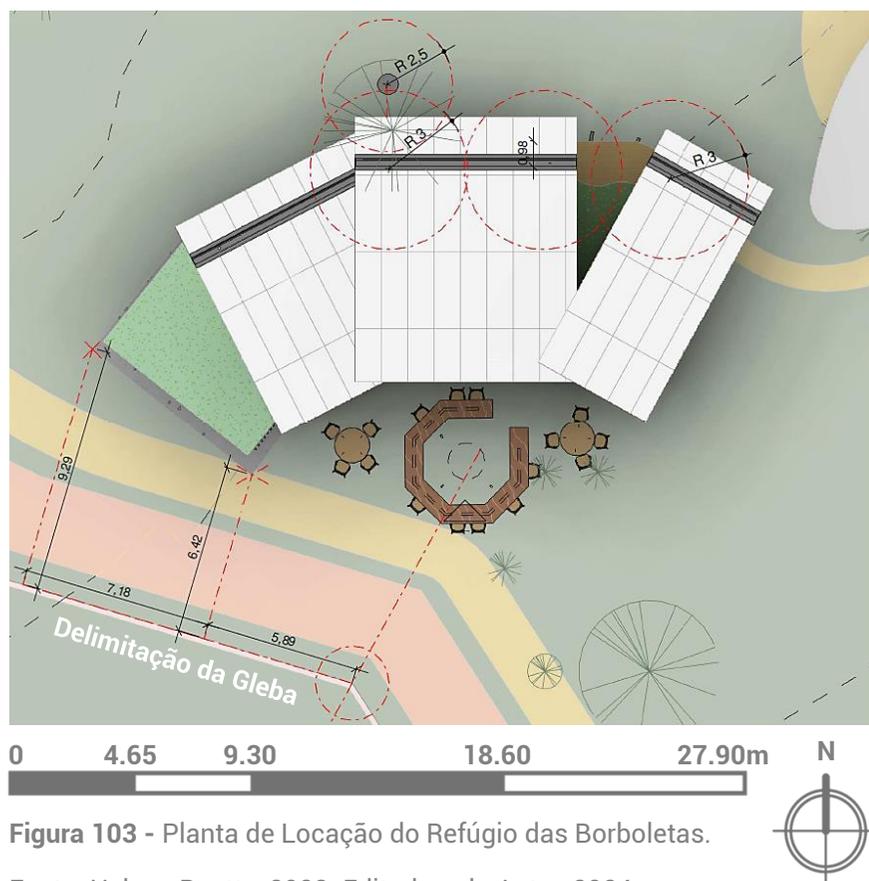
Planta de Locação do Refúgio das Borboletas.
